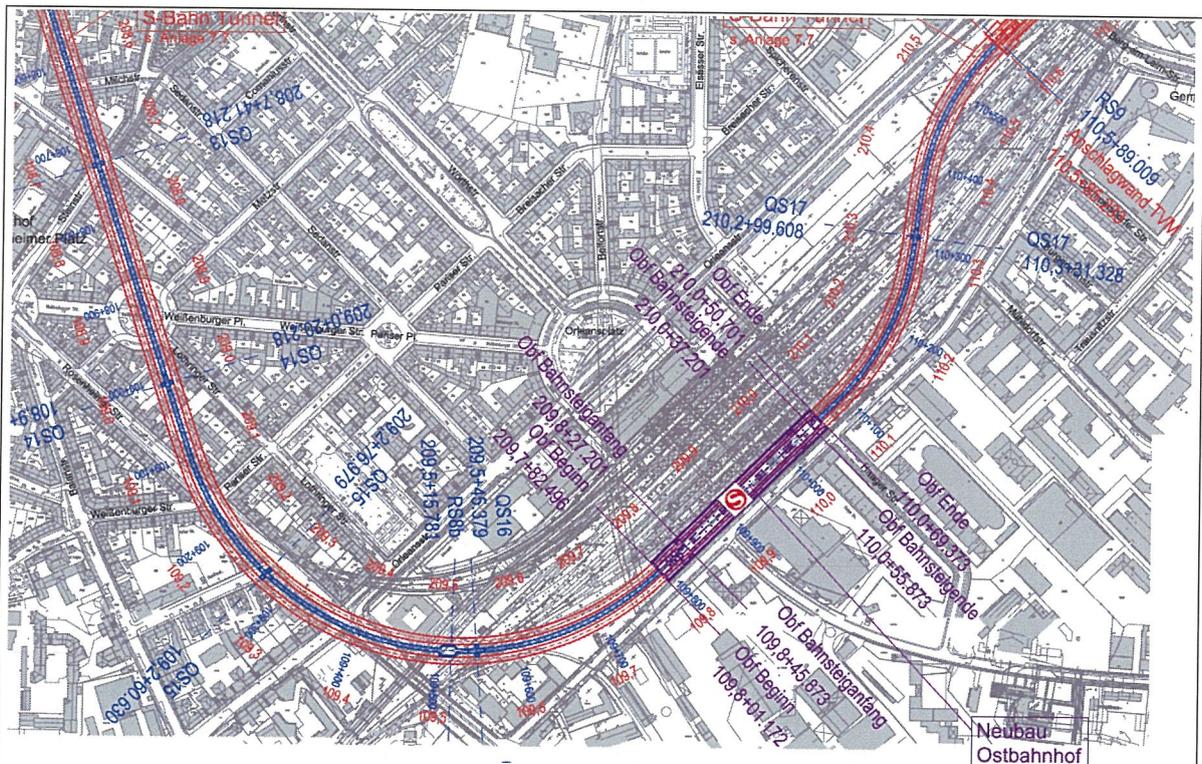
Lage der uPva MOPT südlich der bestehenden oPva Ostbahnhof (Grundriss, Prinzip)
